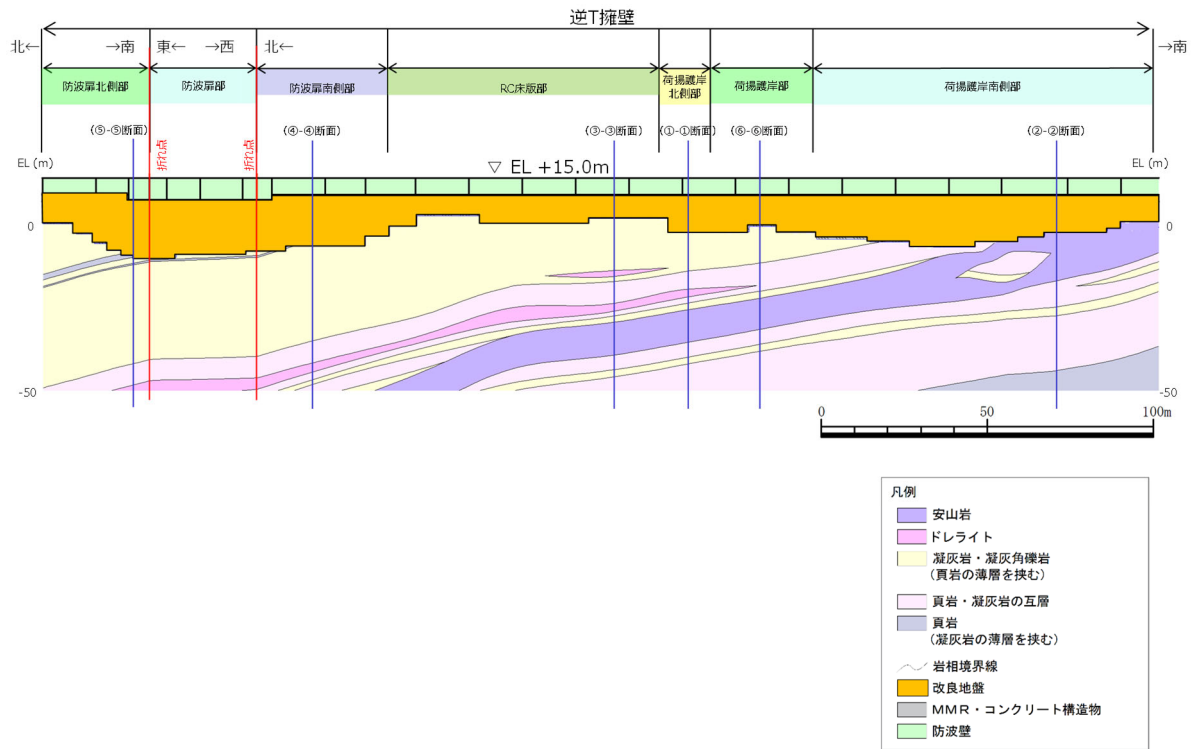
防波壁（逆 T 擁壁）の縦断面図
